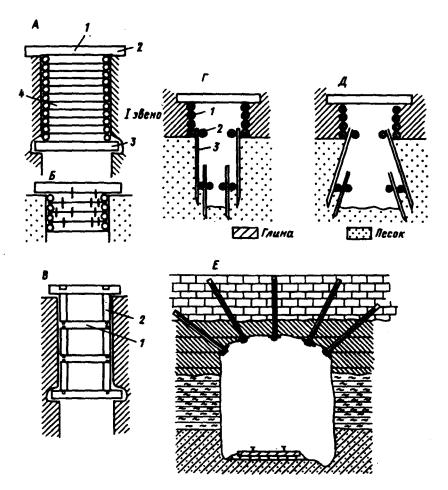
Способы крепления горных выработок. А — сплошное крепление на пальцах; В — сплошное подвесное крепление шурфа; В — крепление на бабках; Γ , Д — забивное крепление с вертикальной и наклонной забивкой крепи; Е — штанговое крепление штольни
